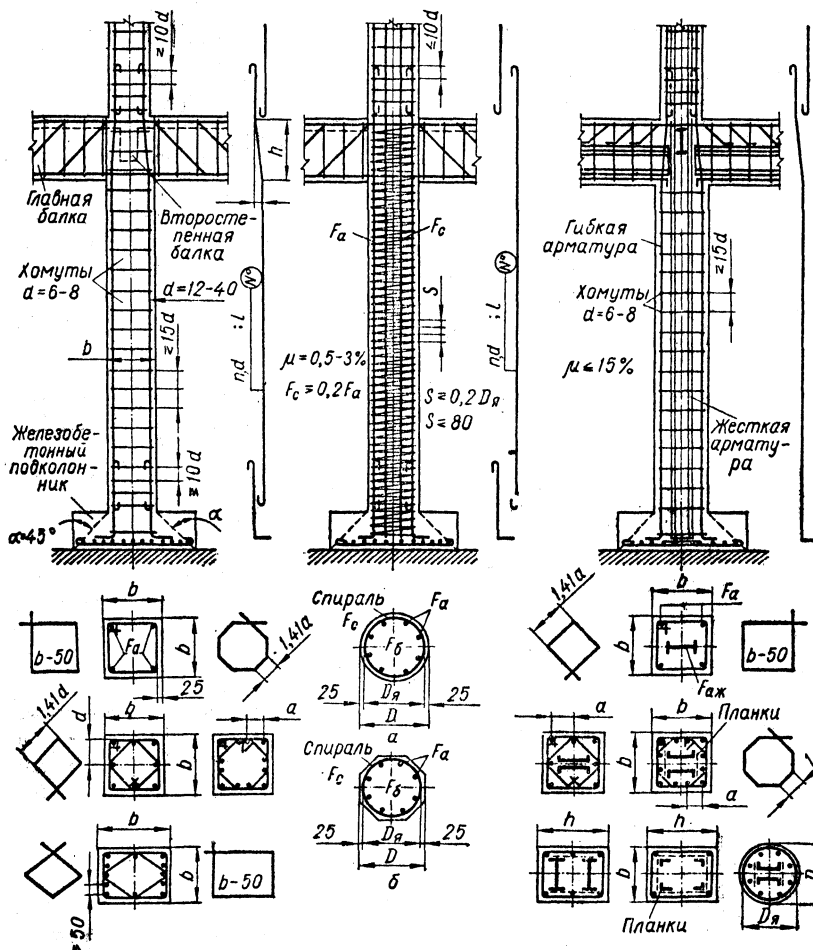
Стойка с гибкой арматурой и обыкновенными хомутами.
